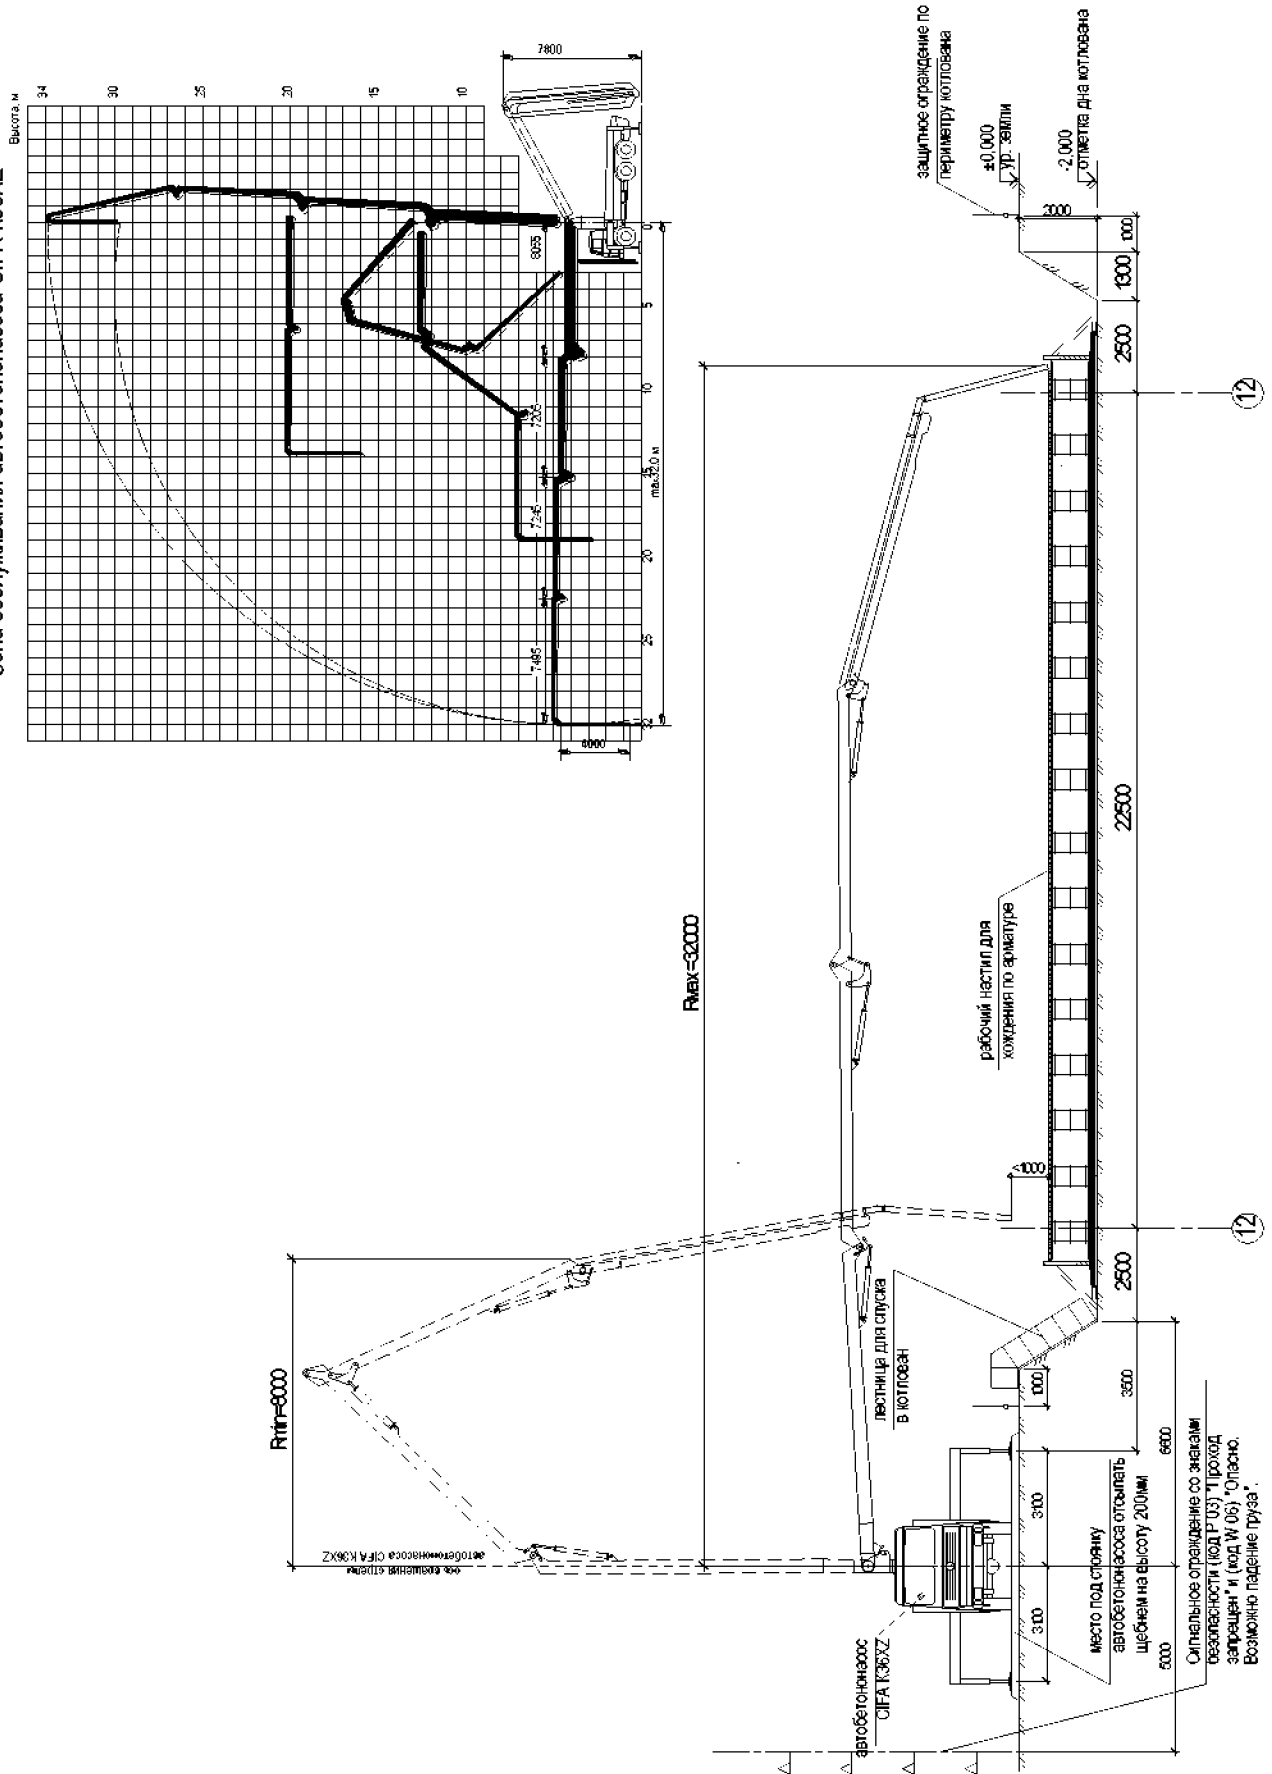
Разрез 1-1 к схеме производства работ по бетонированию фундаментной плиты
